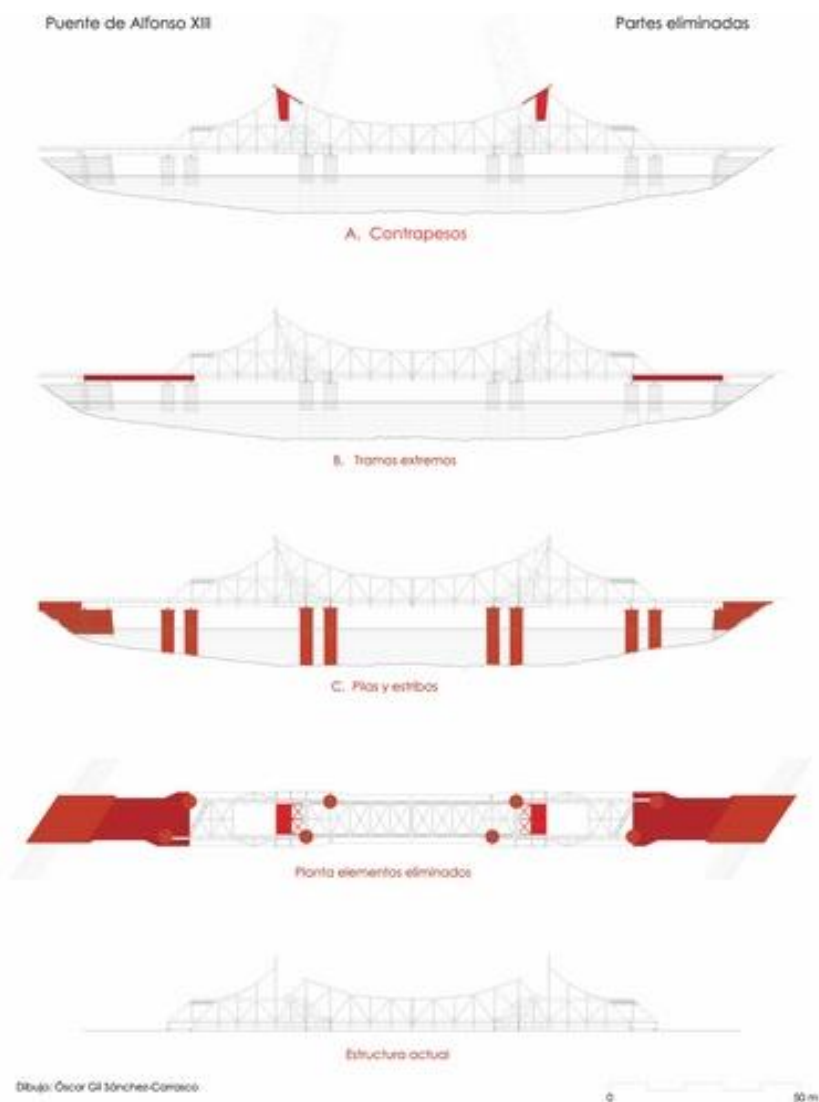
Restos del puente, alzado y planta con los elementos eliminados.
